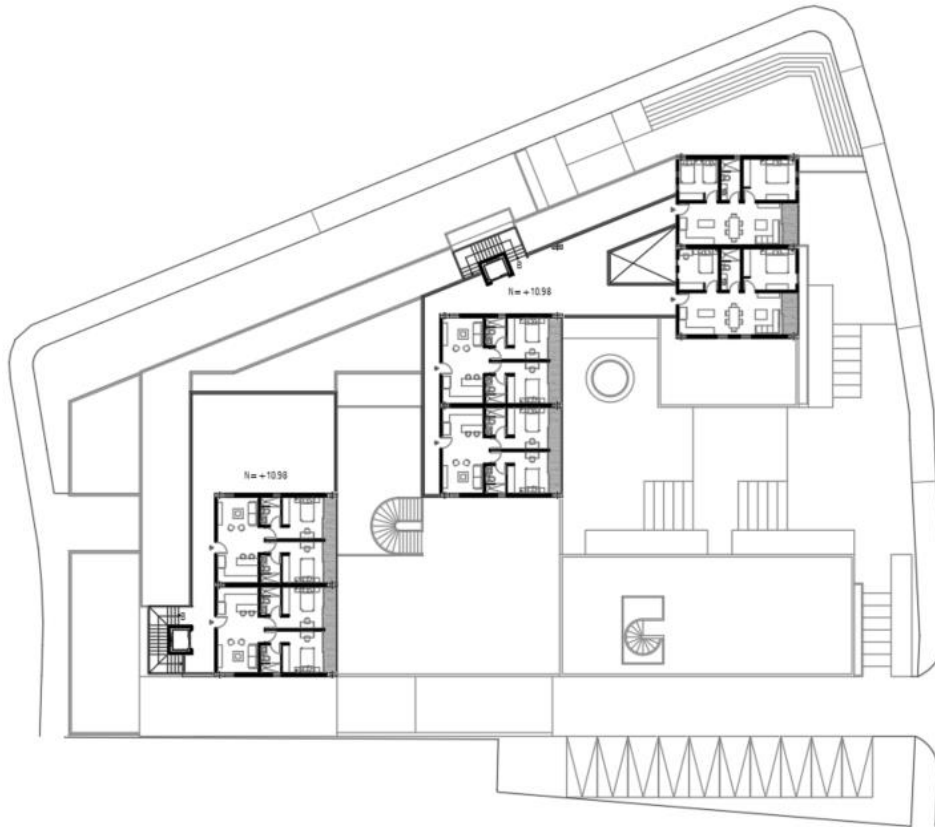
Planta alta 03 - Anteproyecto 02. Elaboración propia.
